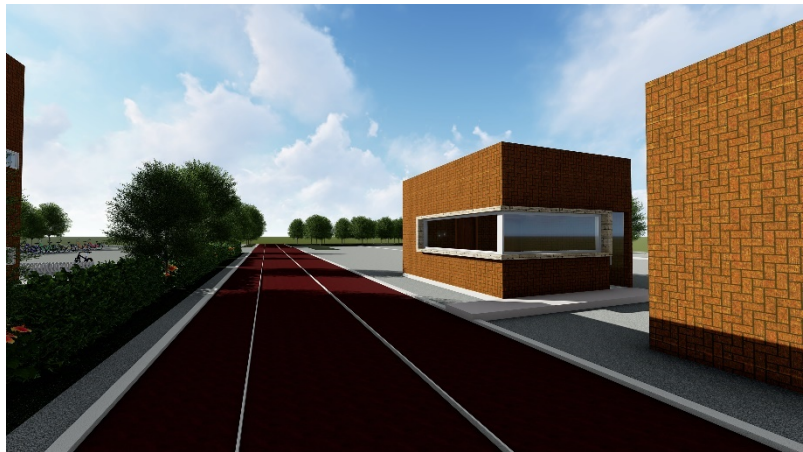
Render Caseta de Vigilancia, Fachada Noroeste (Anexos pág.100)
